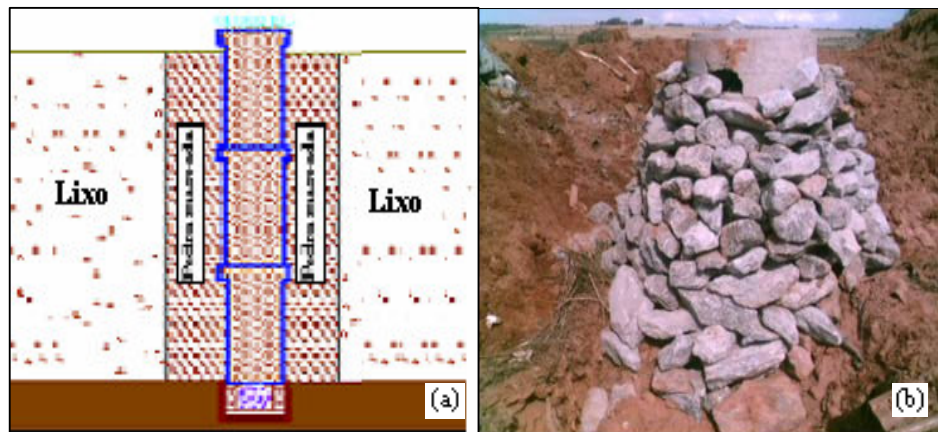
Dreno de gás confeccionado com tubo de concreto furado e preenchido com pedra maroadada, corte vertical (a); vista real do dreno (b)
